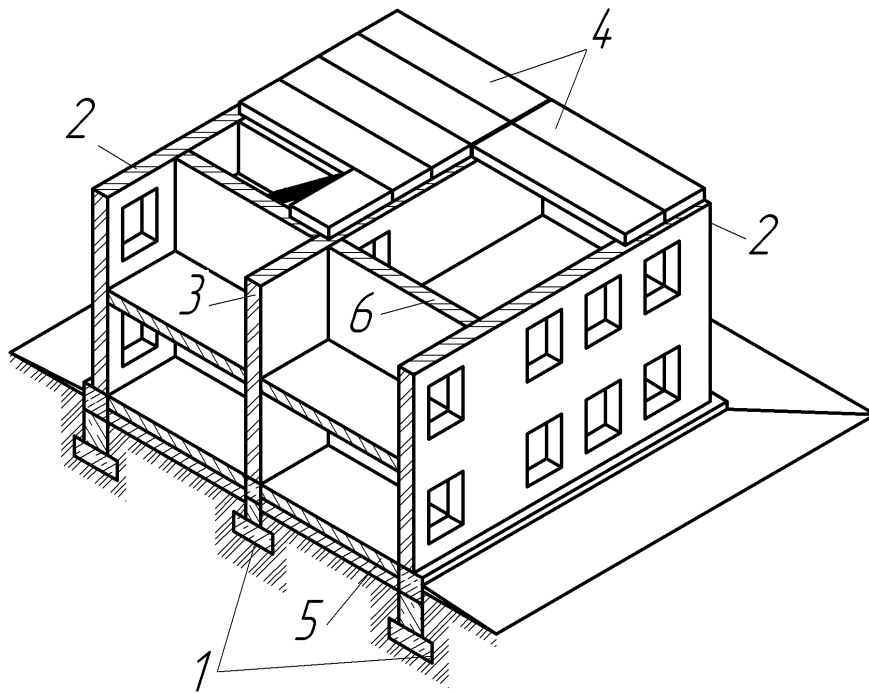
Схемы зданий с различным расположением внутренних несущих стен:
